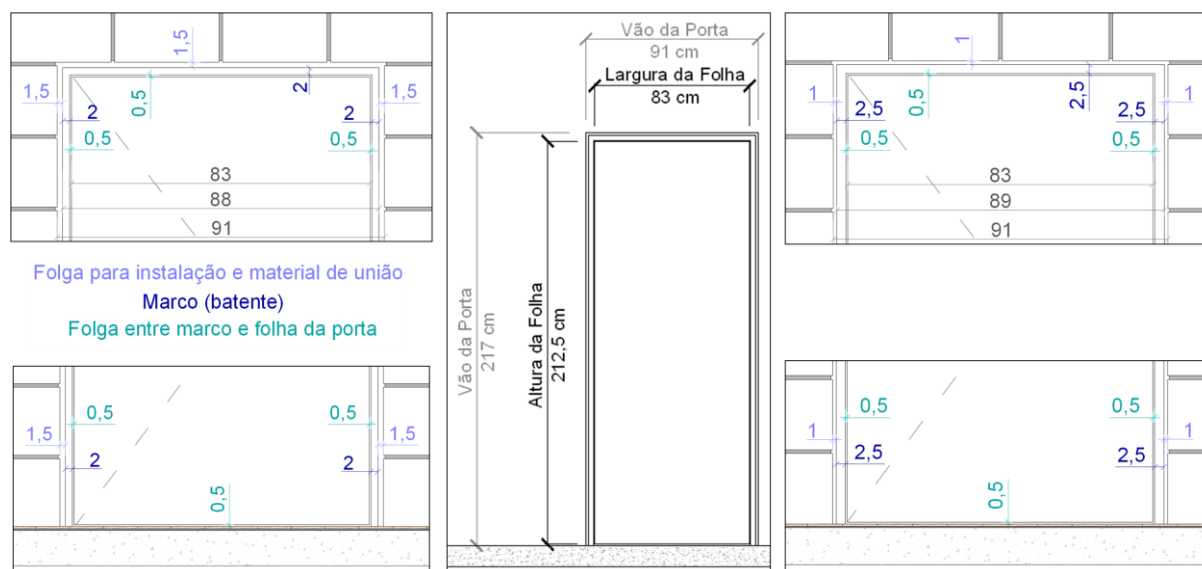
Porta de madeira ideal para projetos de alvenaria estrutural. Vão final 1 / Folha final 3. Batentes de 2 e 2,5 (dimensões em centímetros)
